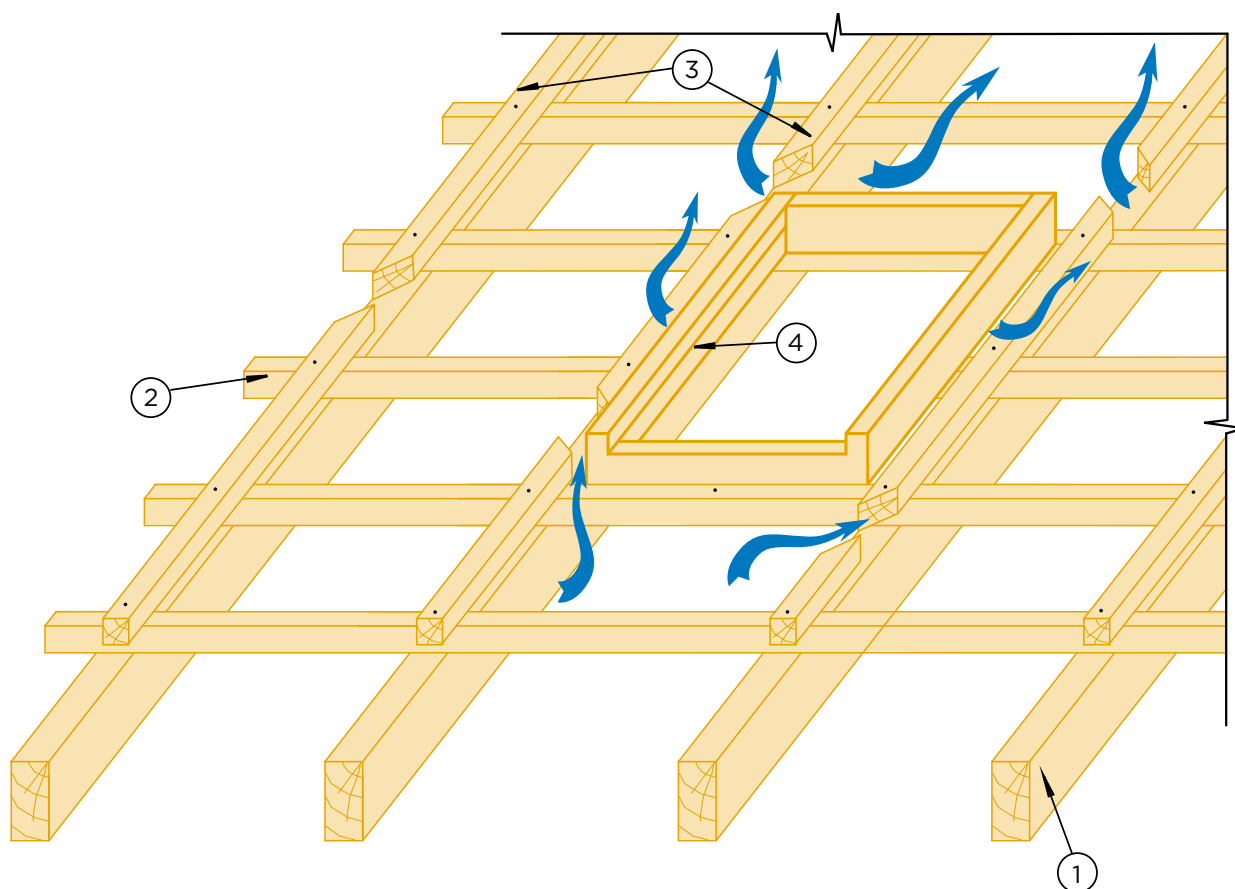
Устройство вентиляционной камеры в зоне мансардного окна
